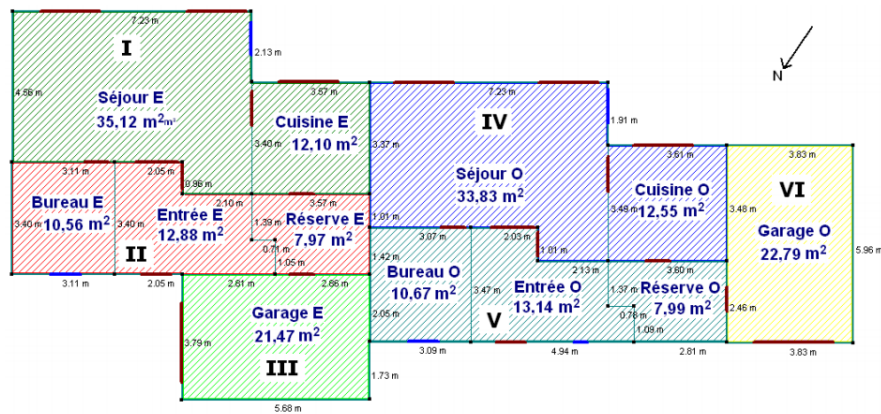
Plan du rez-de-chaussée modélisé
